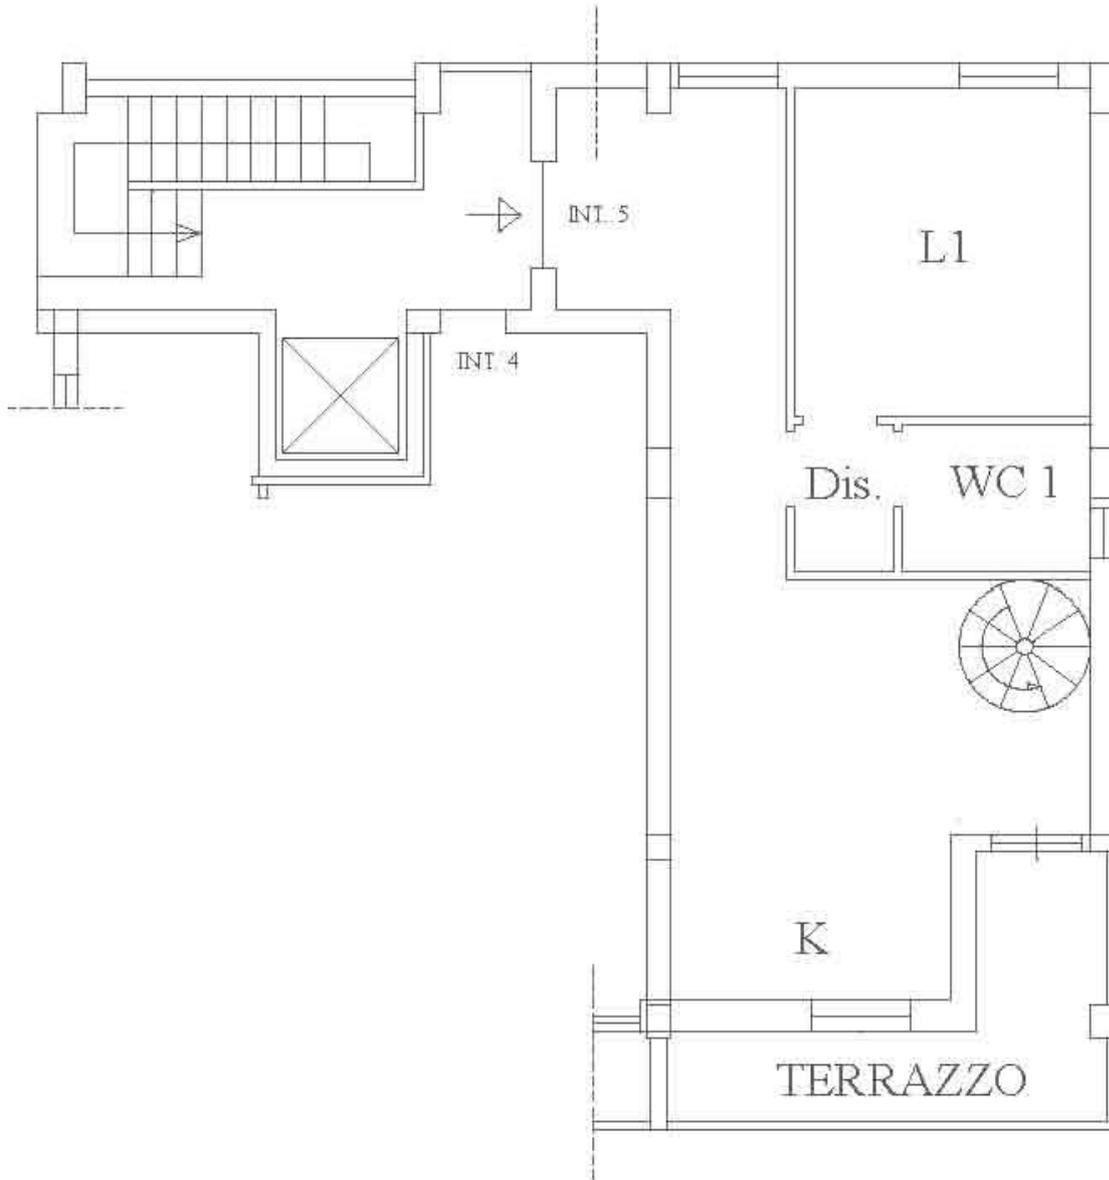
LOTTO N. 4 - RILIEVO METRICO
